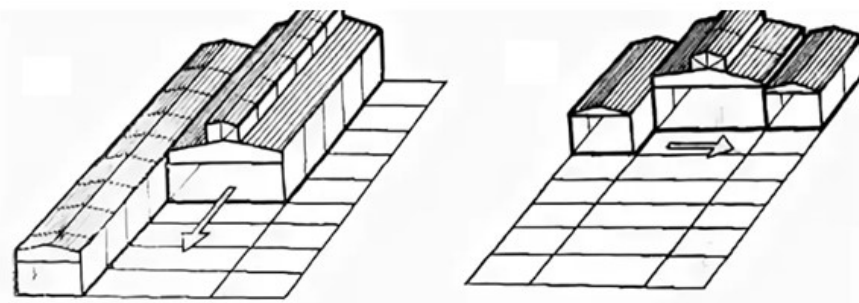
Продольный и поперечный метод монтажа конструкций
